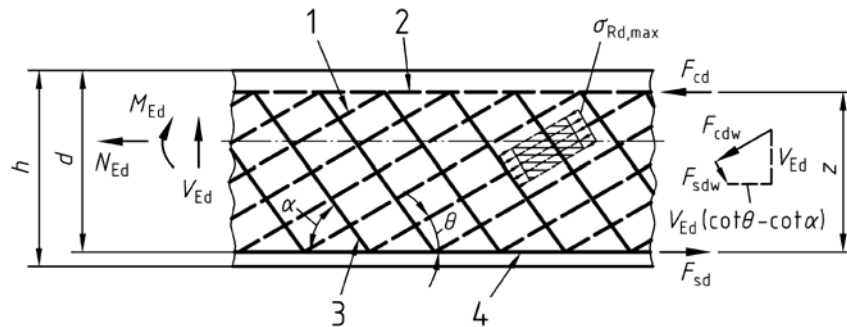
Fachwerk mit veränderlicher Druckstrebenneigung nach DIN 1045-1
